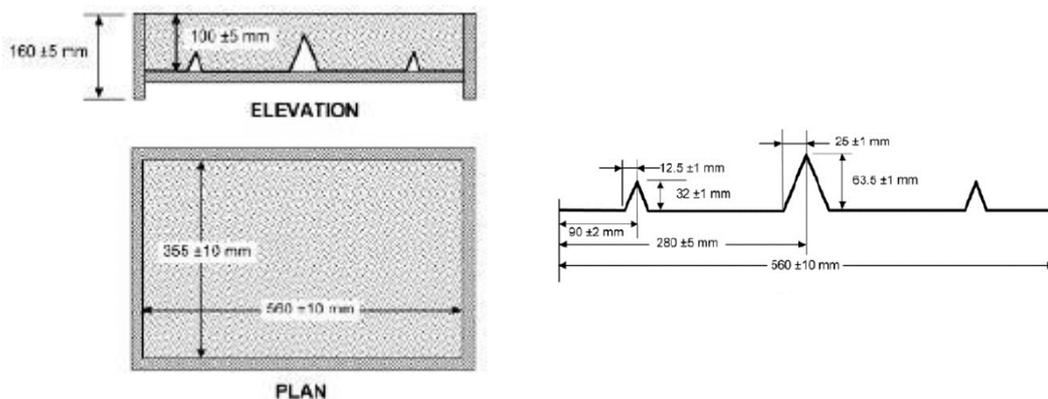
Diseños del molde para en ensayo ASTM C 1579. Obtenido en ASTM C1579 ^(39 p. 2)
